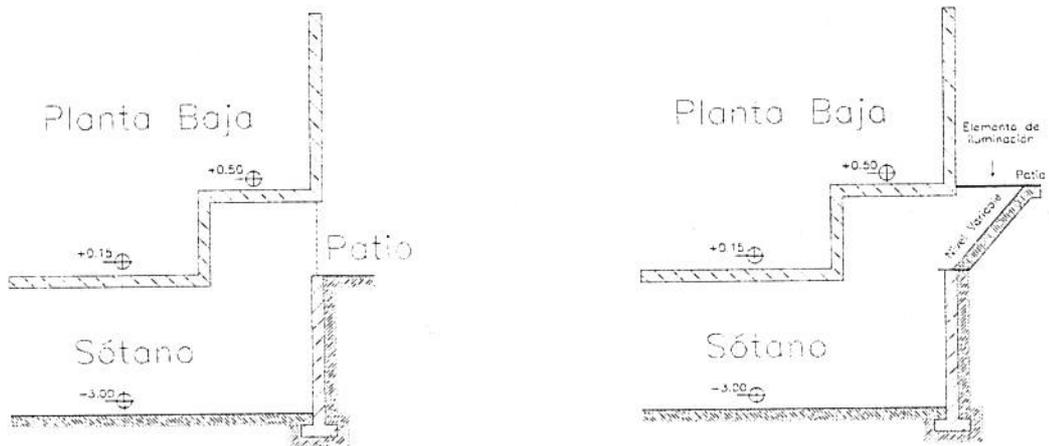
REPRESENTACIÓN EN PLANTA BAJA
